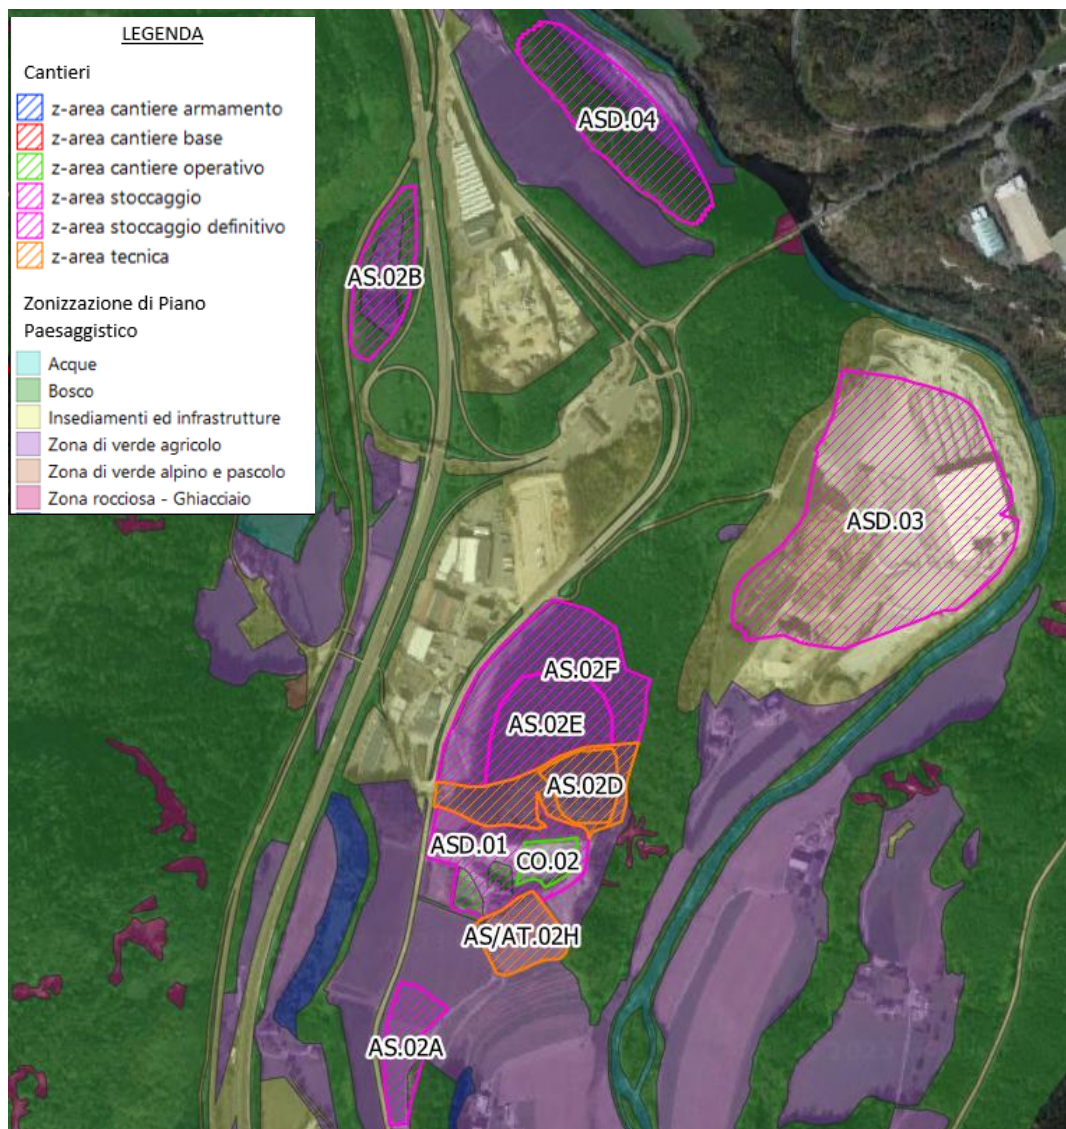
Individuazione delle aree di cantiere dell'ambito Forch con relativa zonizzazione di piano – Progetto Esecutivo
